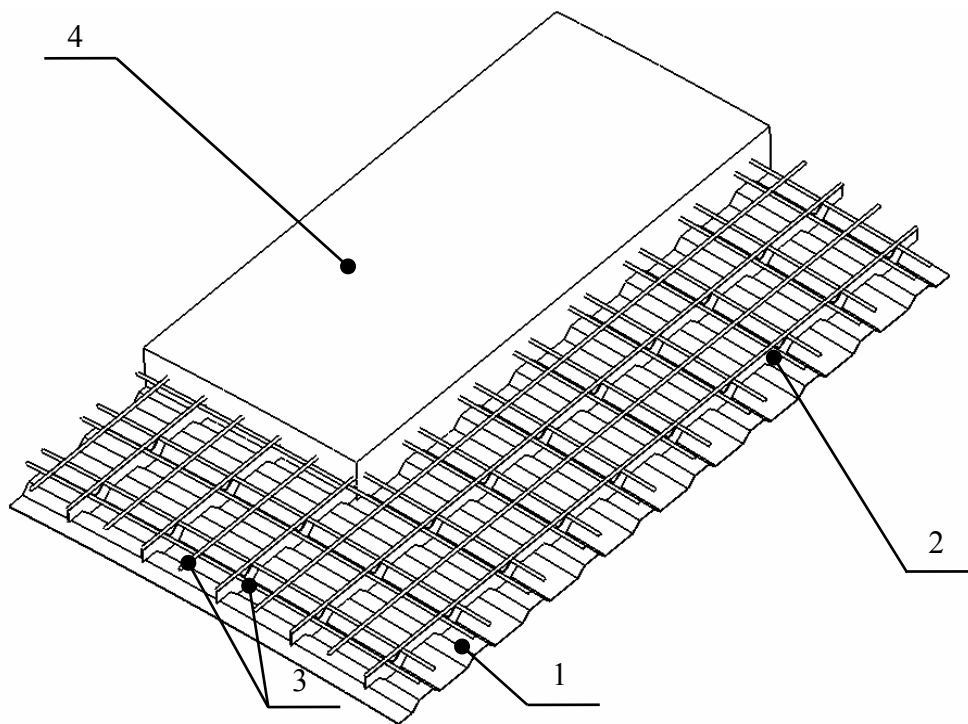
Вариант исполнения секции из композитных несущих элементов для возведения большепролетных самонесущих перекрытий (часть бетонного заполнителя не показывается): 1 – формообразующий лист; 2 – листовая арматура; 3 – стержневая арматура; 4 – бетонный заполнитель
